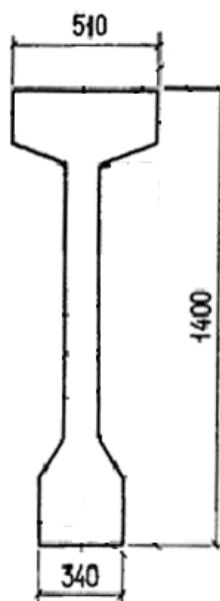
Підкранова балка двотаврового перерізу
